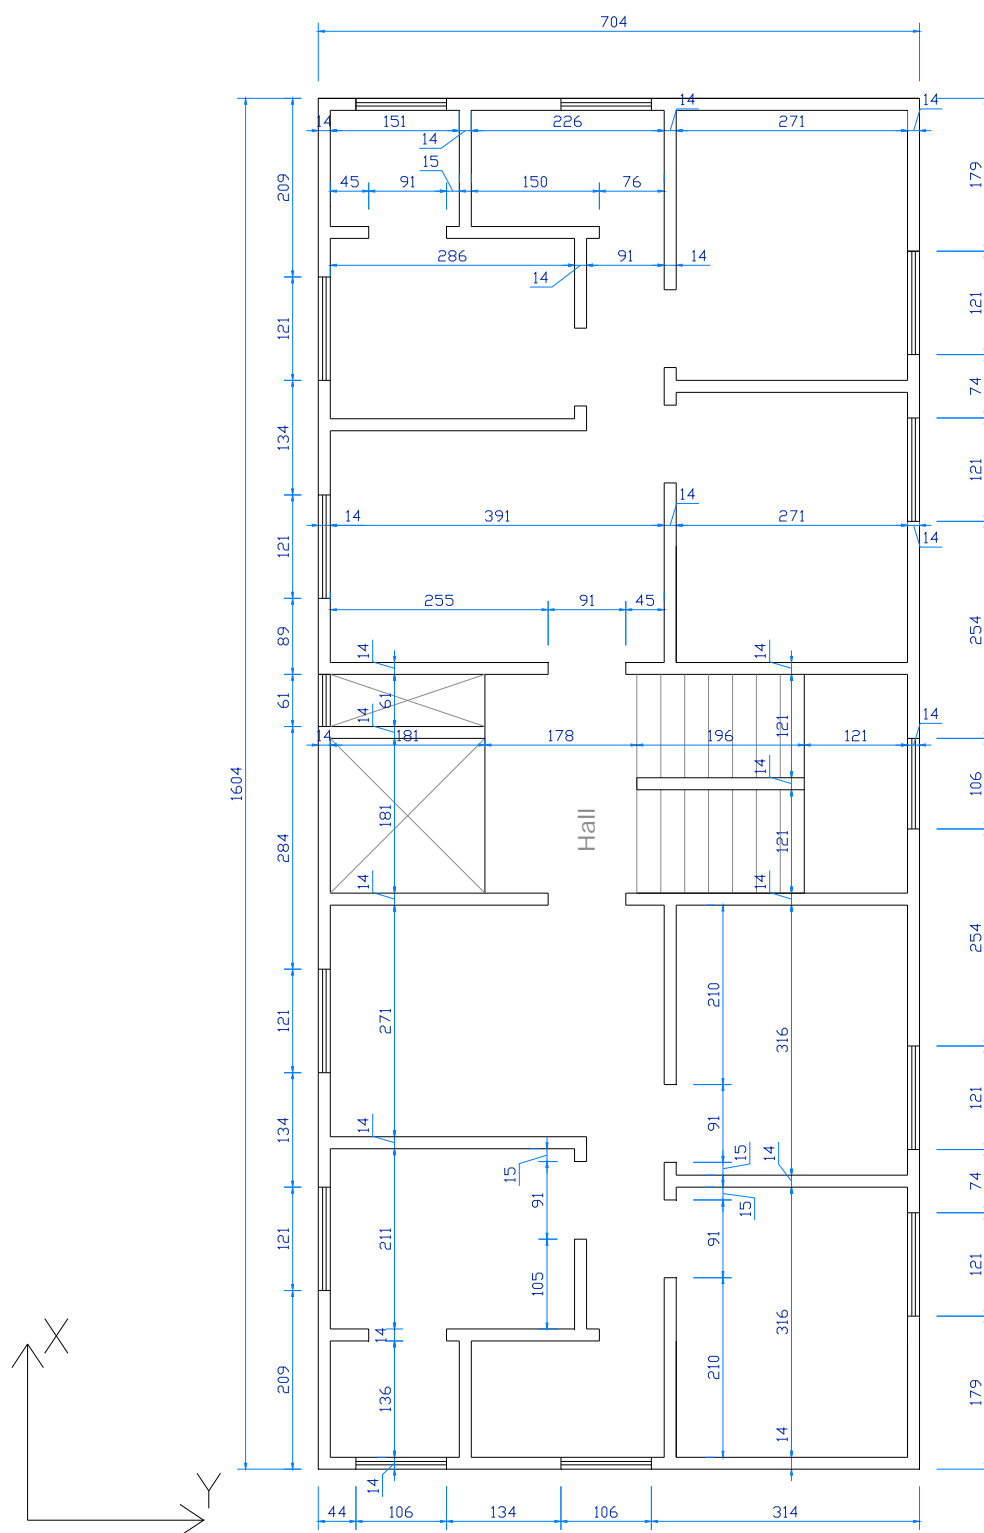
Arranjo arquitetônico do pavimento tipo.
